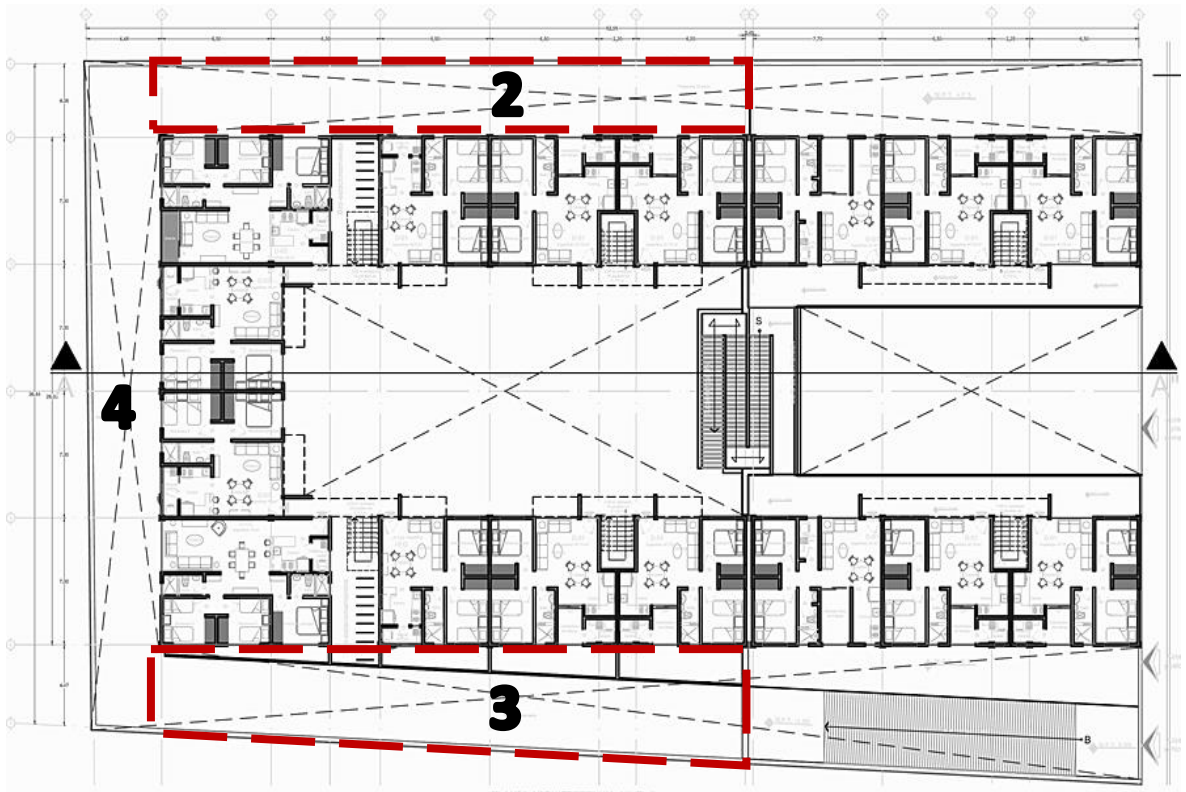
Plano arquitectónico (planta nivel 1).
